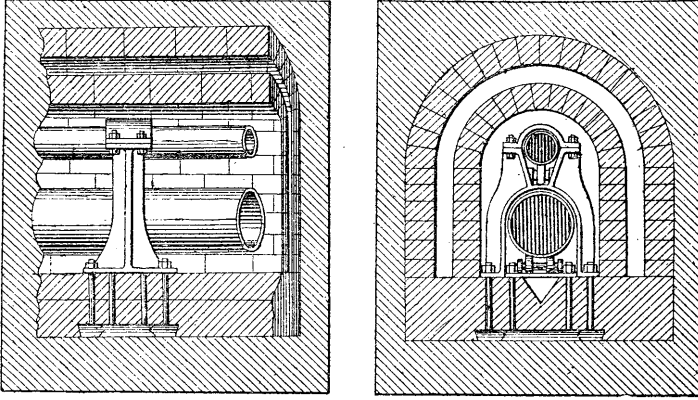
et 217. — Coupe longitudinale et transversale d'un caniveau.
